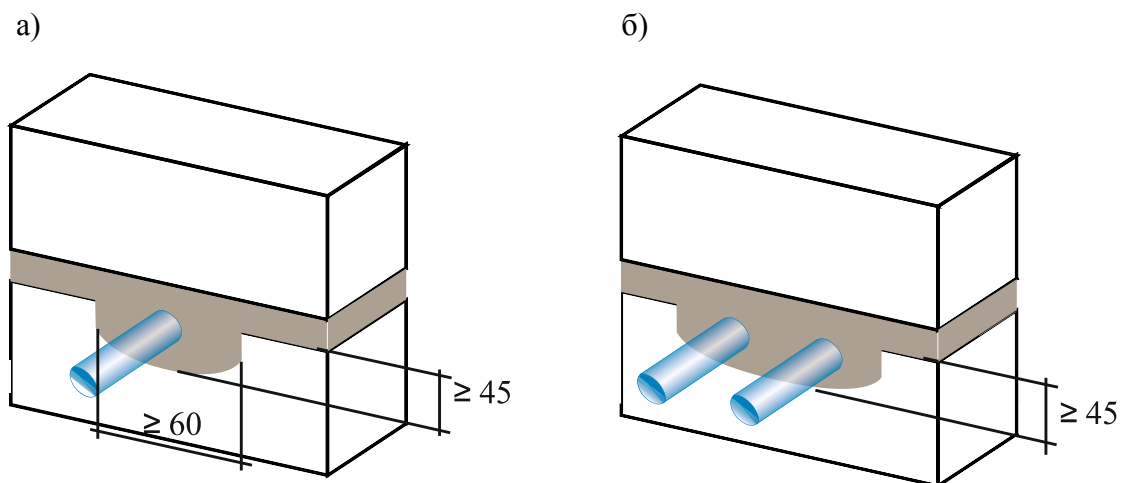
Расположение одиночных (а) и двойных арматурных стержней в горизонтальных швах кладки их каменных блоков[10]
